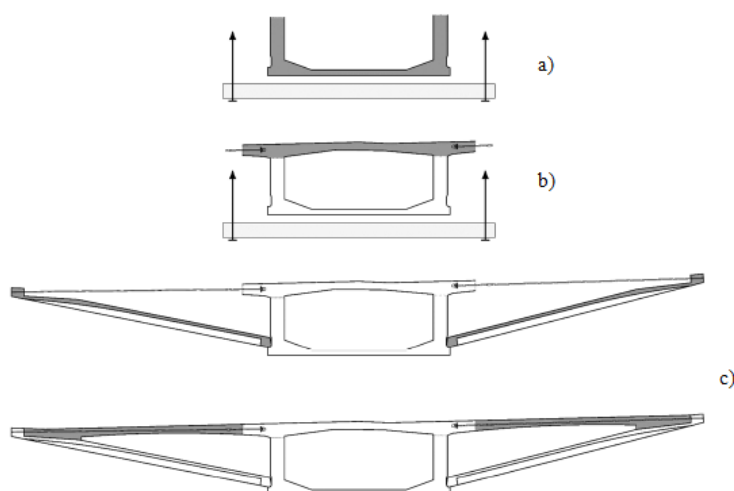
Exemplo de betonagem de seção em caixão: primeira fase a); segunda fase b); terceira fase c)
